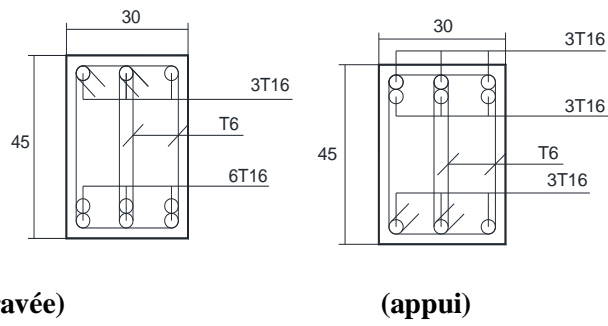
Ferrailage d'une poutre secondaire 30x45cm (plan avec longues travées)
